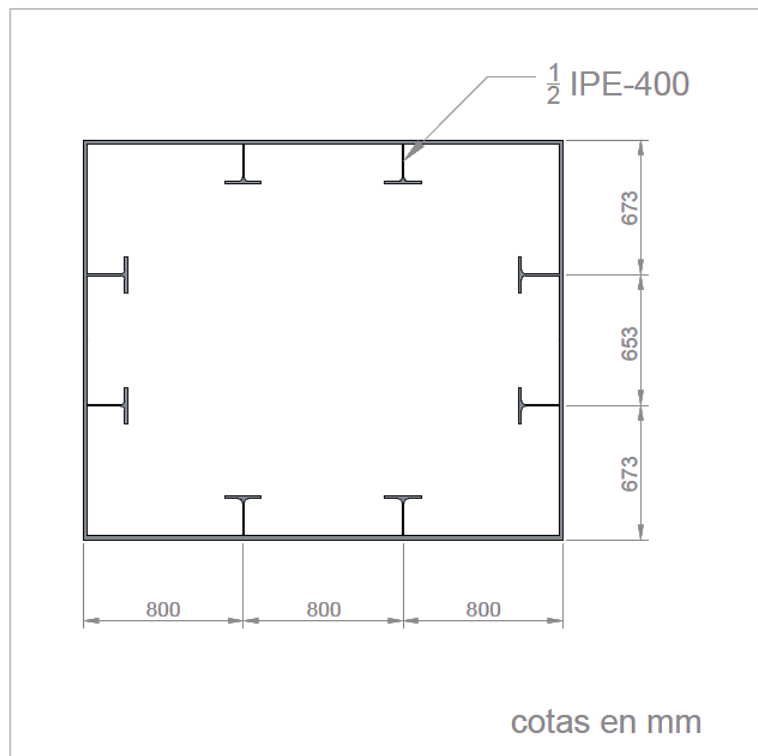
4. Rigidizadores longitudinales en las vigas cajón.
